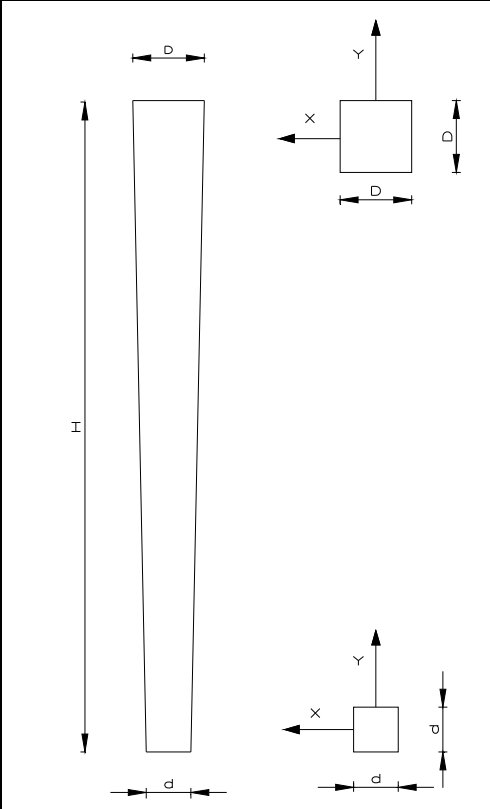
LEVANTAMIENTO TOPOGRÁFICO Y OBTENCIÓN DE ACERO DE REFUERZO COLUMNAS (1)
